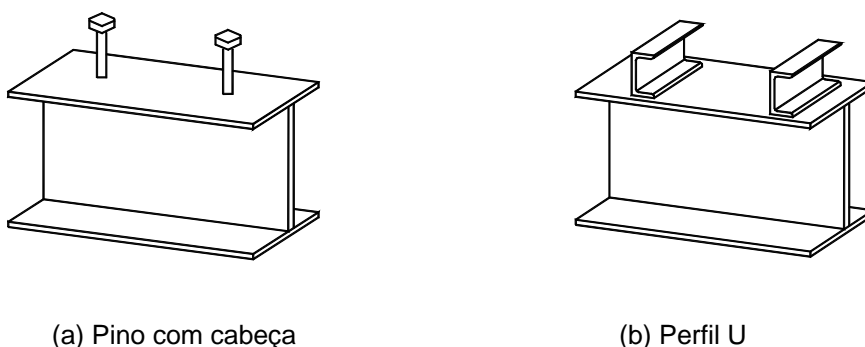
Ligação de cisalhamento entre a laje de concreto e a viga de aço
